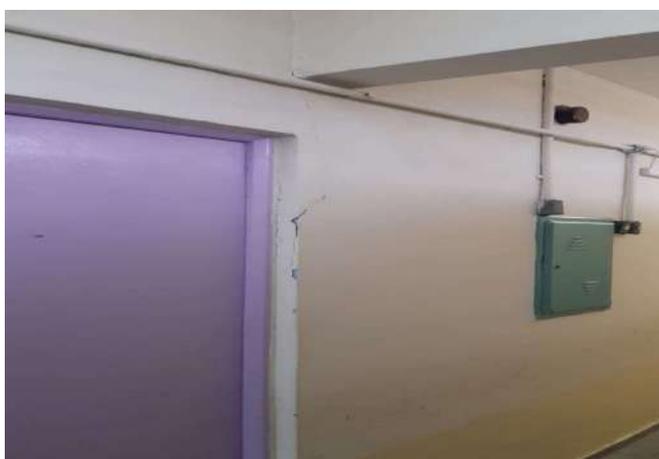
TRINCA NA PORTA DA SALA DA BRINQUEDOTECA
